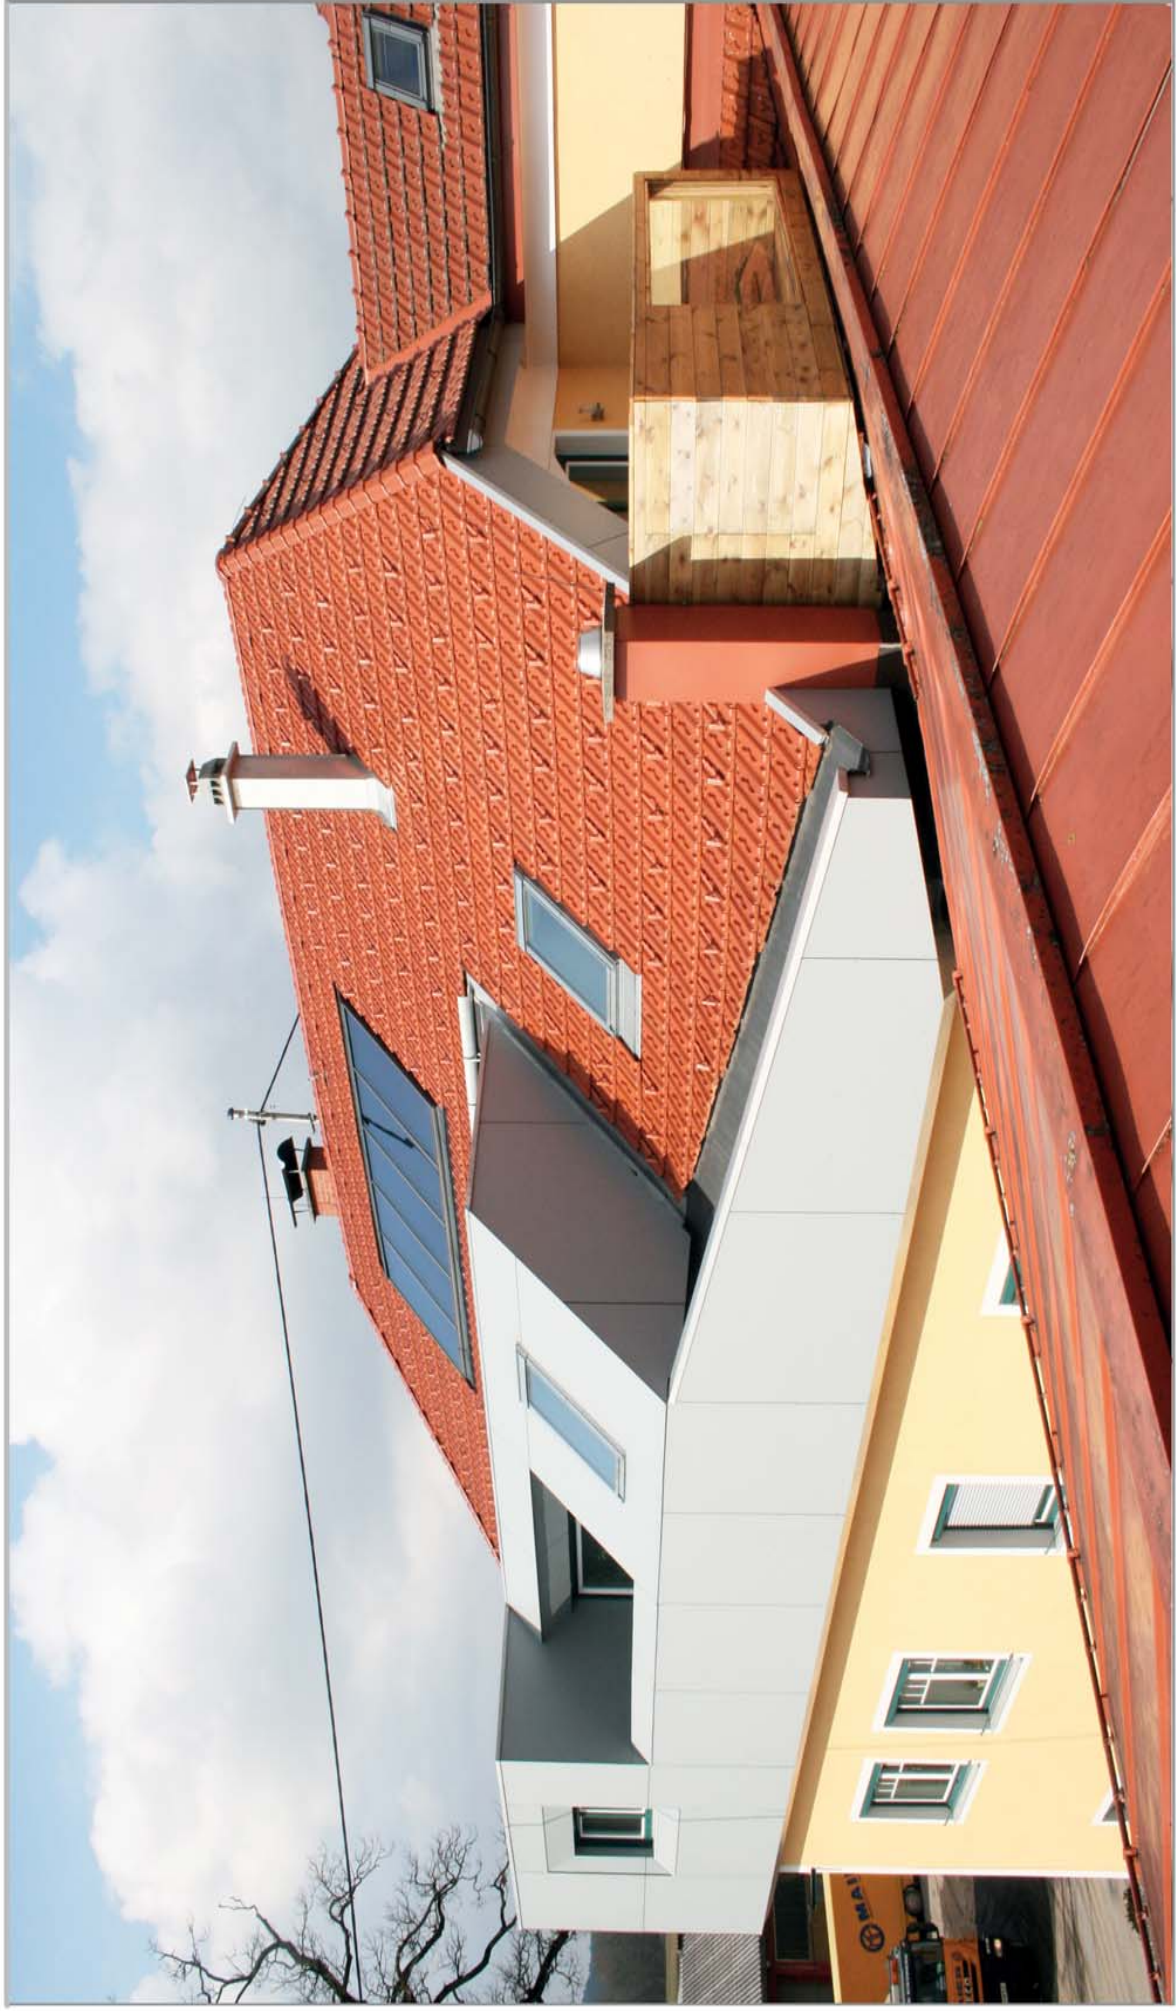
Außenansicht Dachgeschoßausbau / exterior view extension
